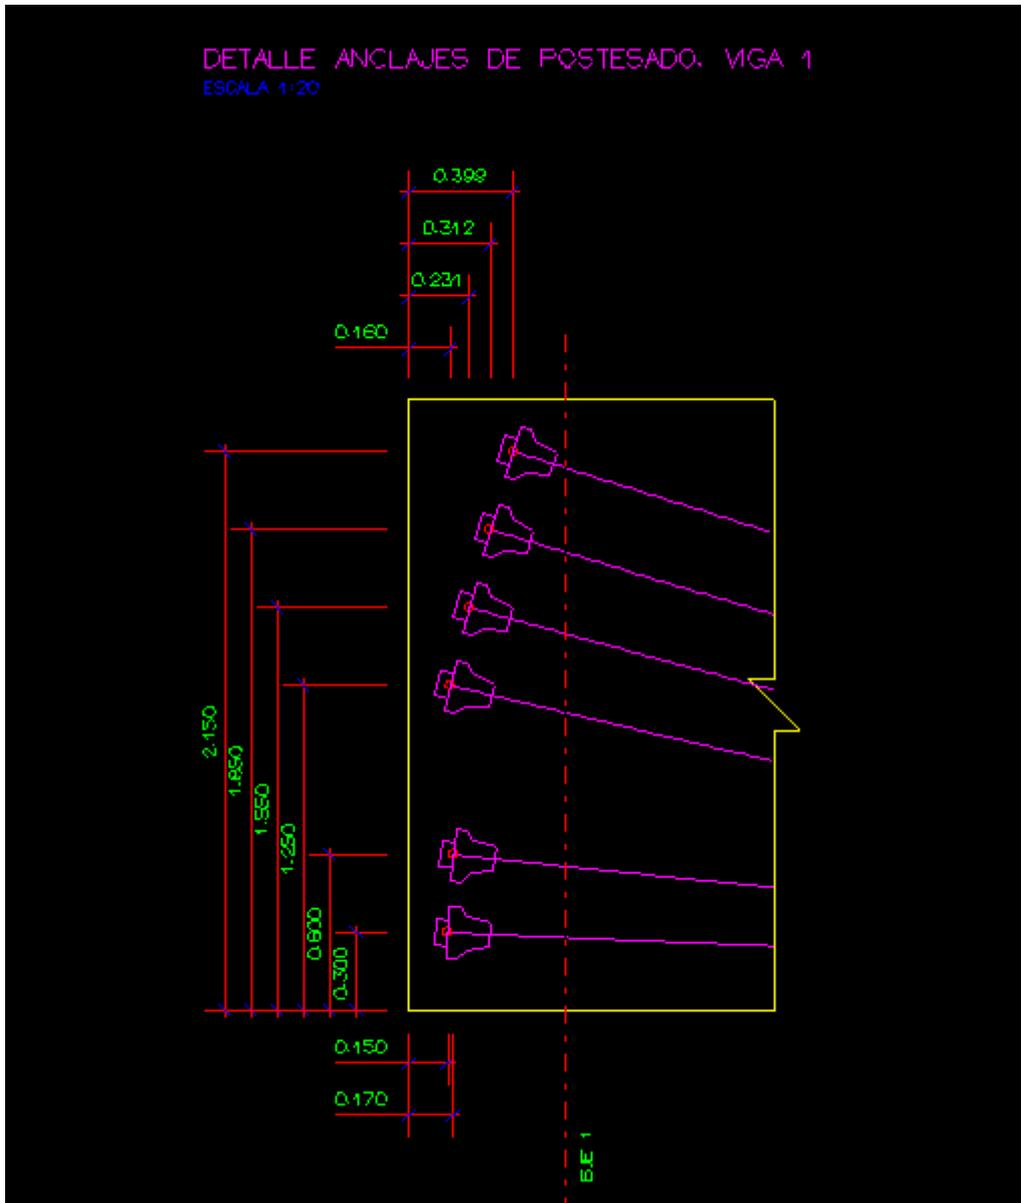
Figura *Detalle de los anclajes de postensado*.
